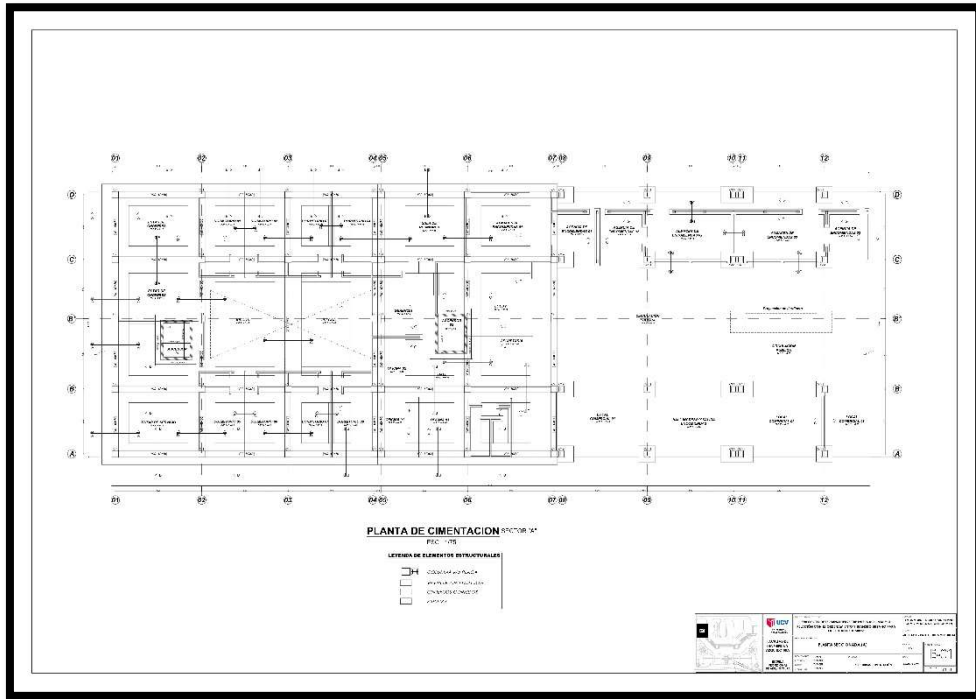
Plano de Cimentación Sector (A) Fuente: Elaboración Propia.
